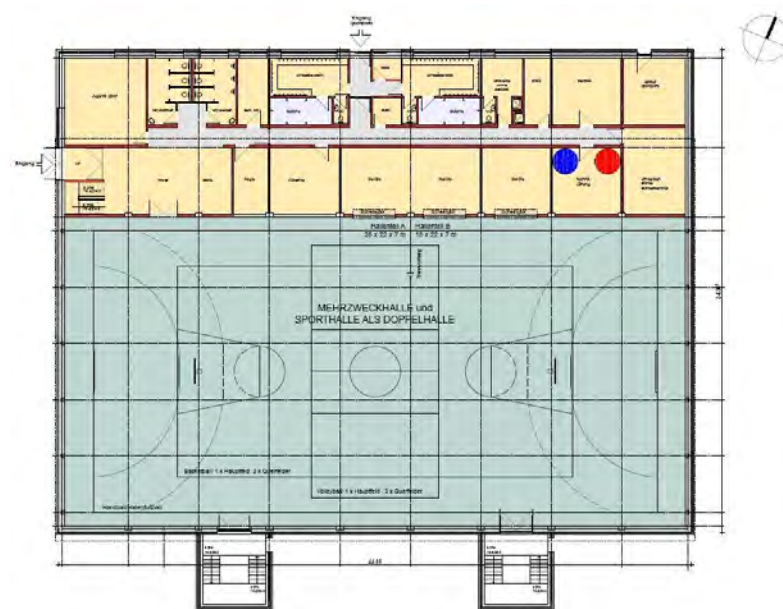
Südansicht und Grundriss (Stand Februar 2008, siehe auch Anlagen)
